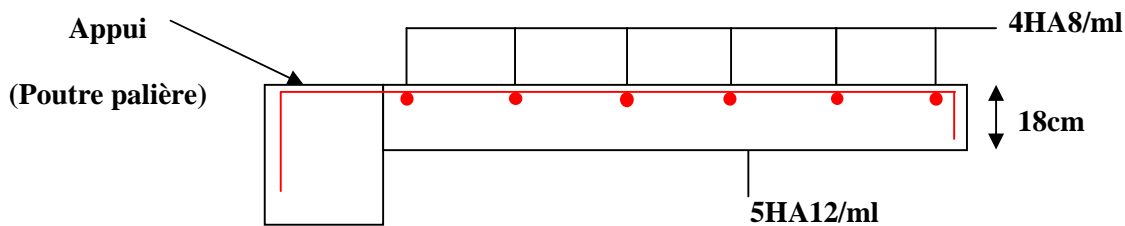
schéma de ferrailage du palier en consol de l'escalier étage courant
